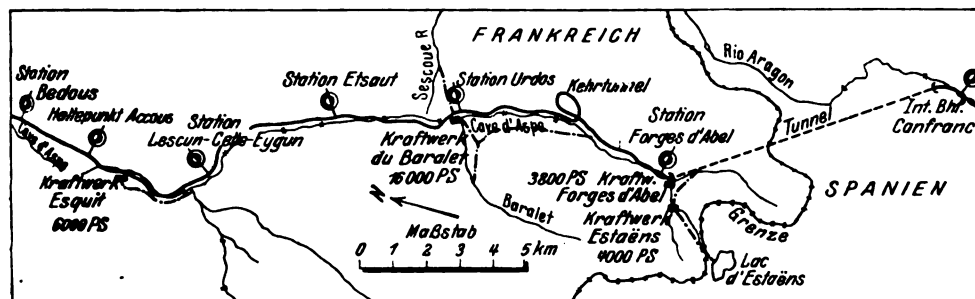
Lageplan der jetzt ausgeführten Strecken.
